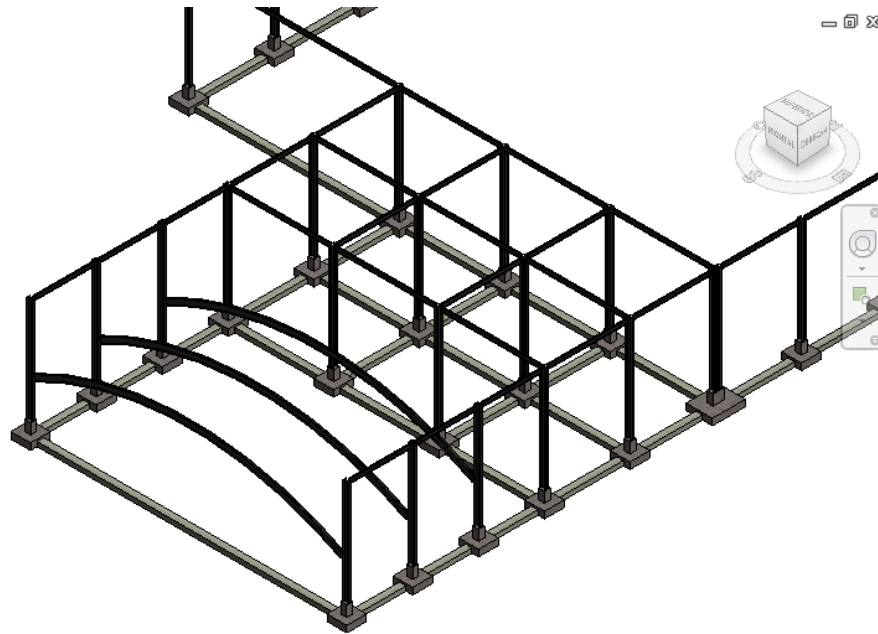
Inclusión de arcos en la zona del voladizo sobre la que apoyará la primera planta de oficinas.
